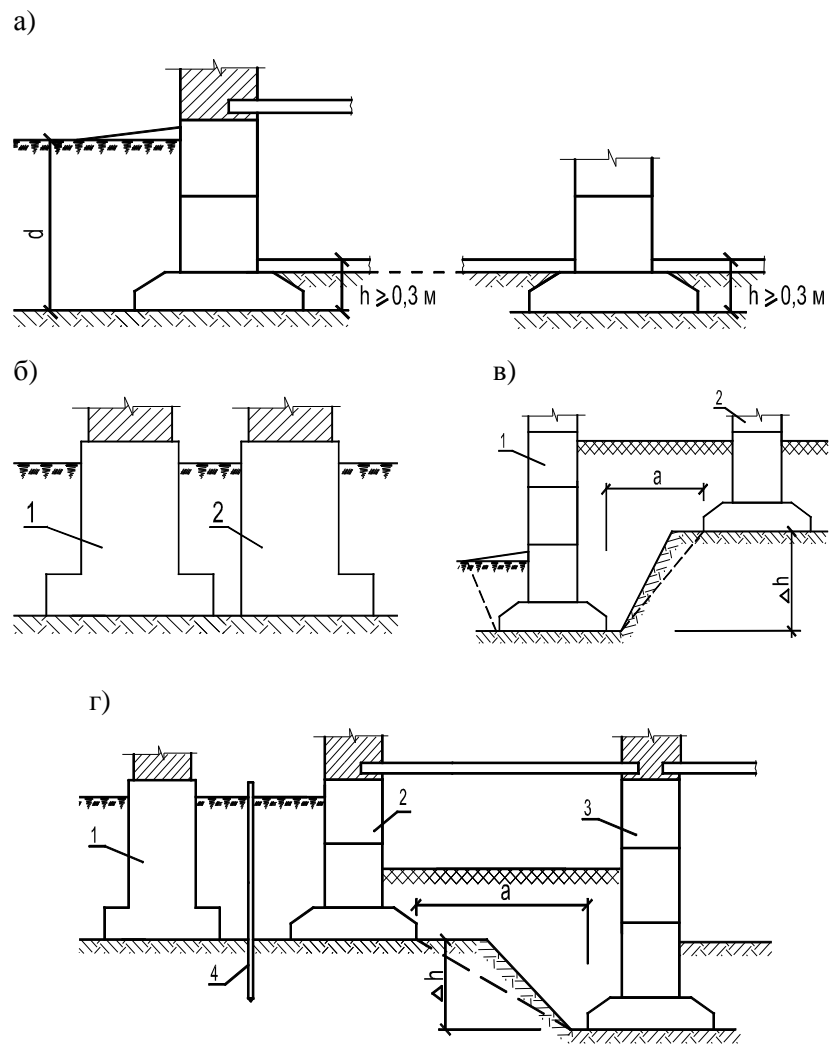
Схемы заложения фундаментов по конструктивным особенностям: 1 – фундамент существующего здания; 2 – фундамент нового здания; 3 – фундамент с большей глубиной заложения; 4 – шпунтованная стенка.
